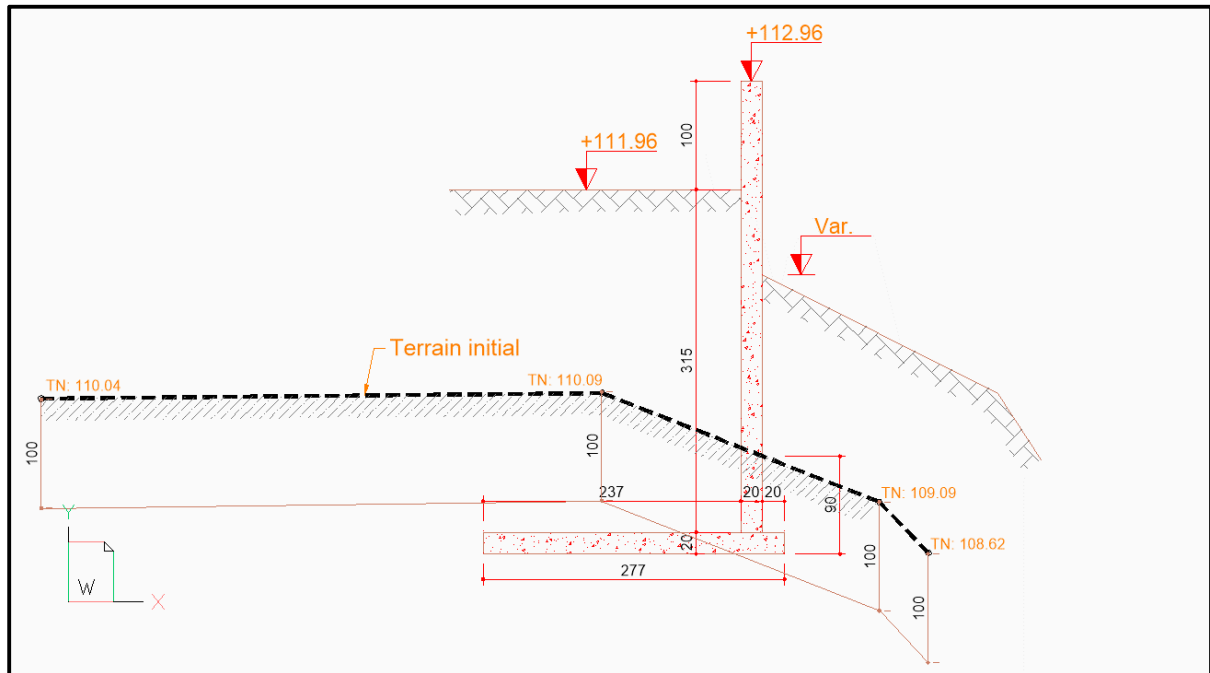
Vue en coupe E-E du mur de soutènement M12 et des murs de rampe M5 et M10
